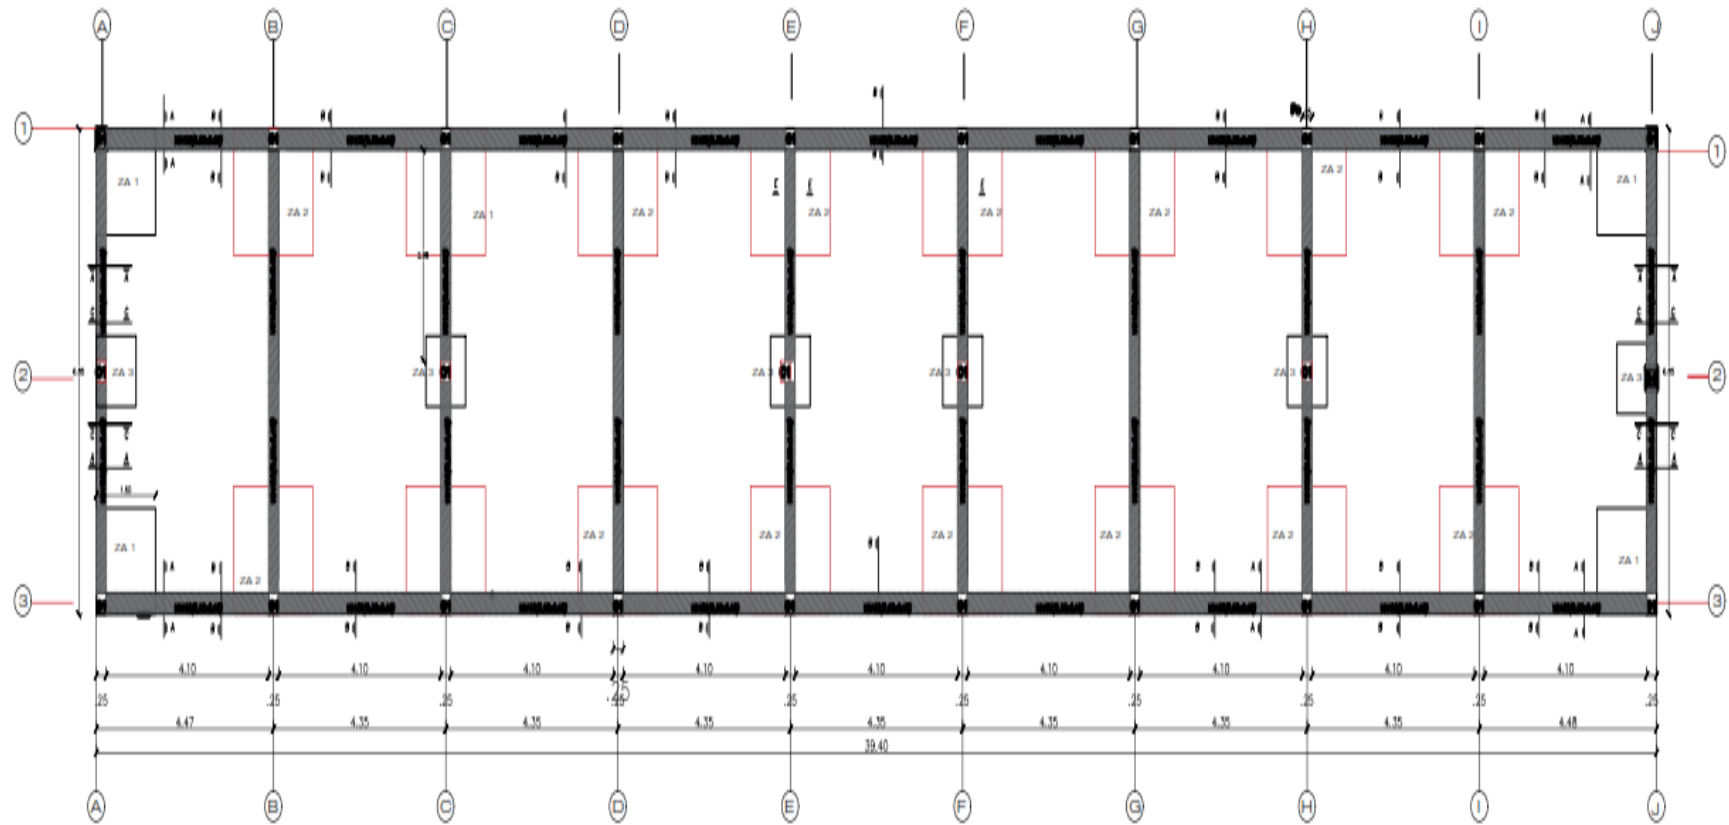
Plano de arquitectura del I.E Fe y alegría N°14
